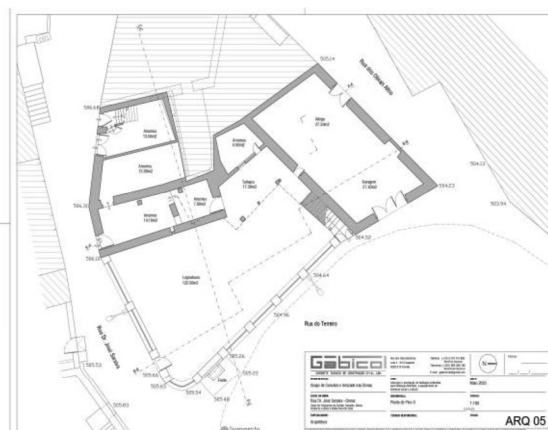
Planta do existente do piso 0. Fonte: GABICOL
